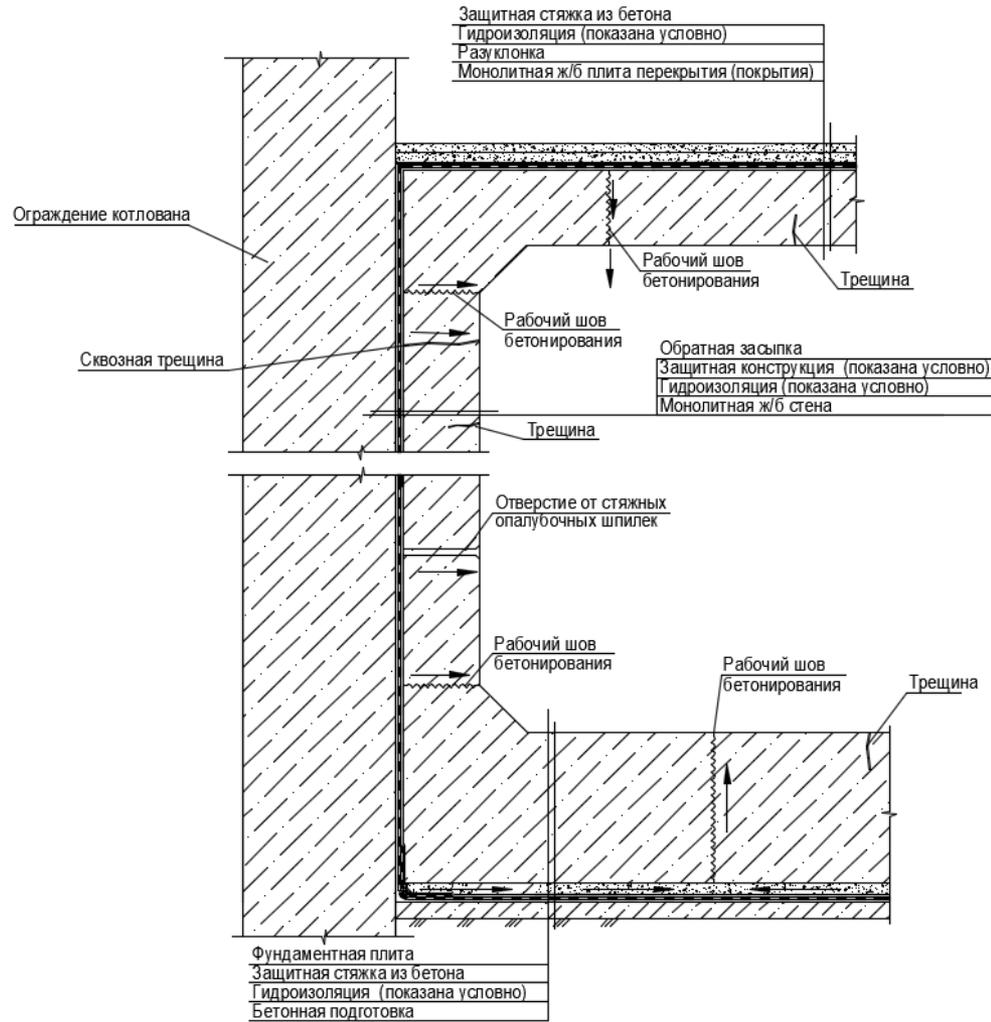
Схема локальных мест водопроявлений с обеспеченной адгезией гидроизоляции к бетону.
